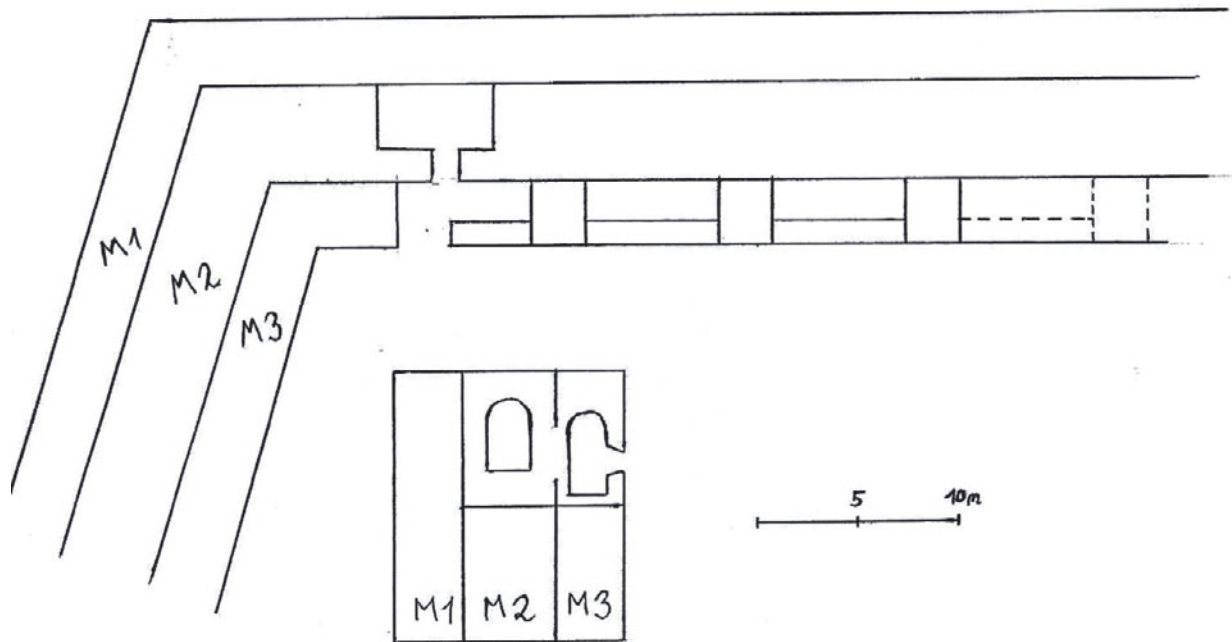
Bauphasen der Seemauer. Grundriss der Ecke nördlich des Belisar-Turms mit den später zugemauerten Arkaden.
